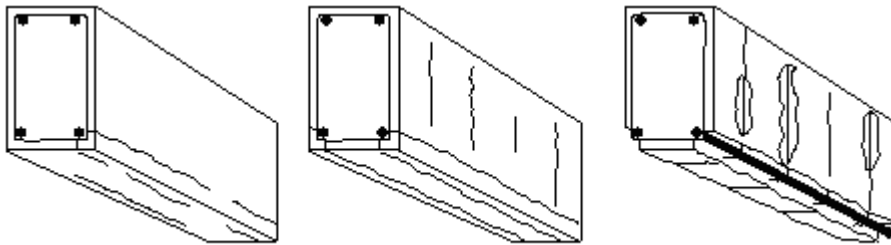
Fisuras de Tracción en dirección paralela.
